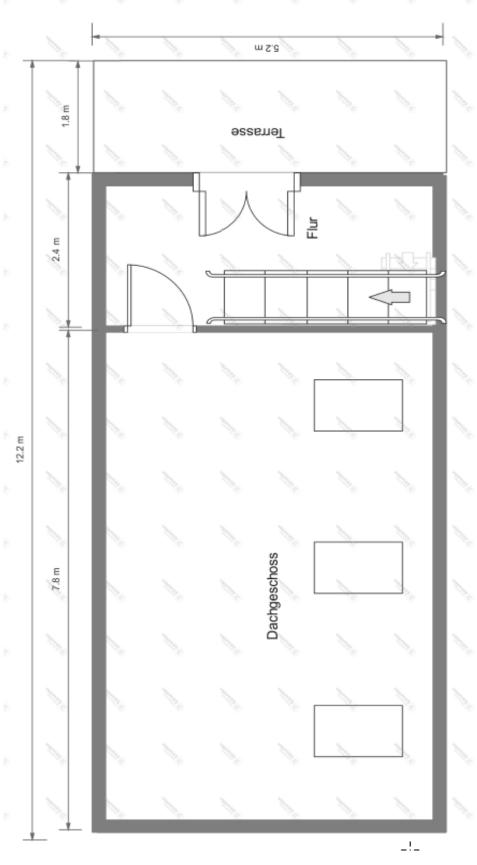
Grundriss DG, nicht maßstabsgetreu, Maße ohne Gewähr
